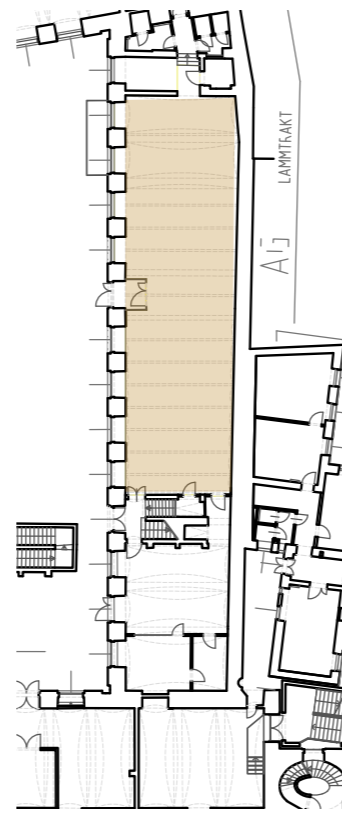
Grundriss ZS7 Ella-Briggs Baumfeld
